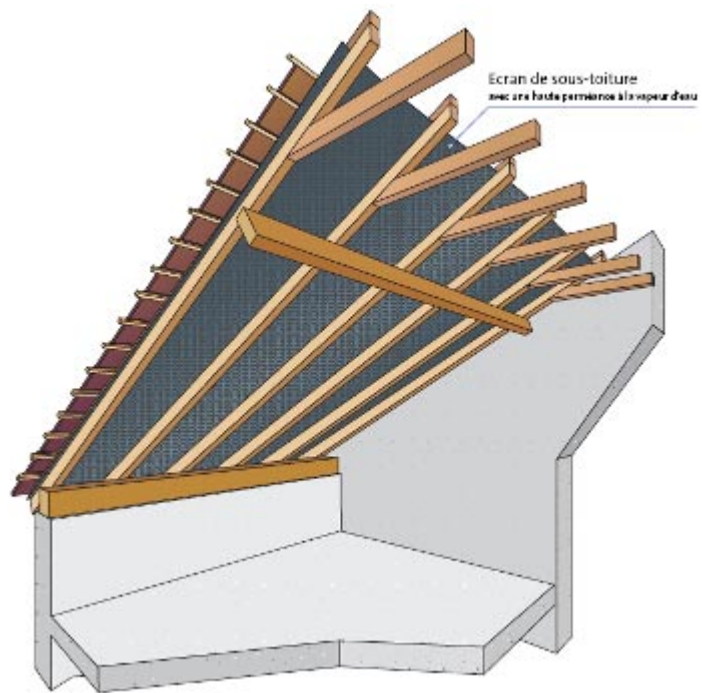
Ecran de sous-toiture en place en charpente traditionnelle
